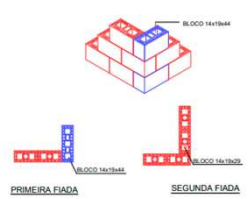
e 2. Detalhes de amarrações em T e de canto.
